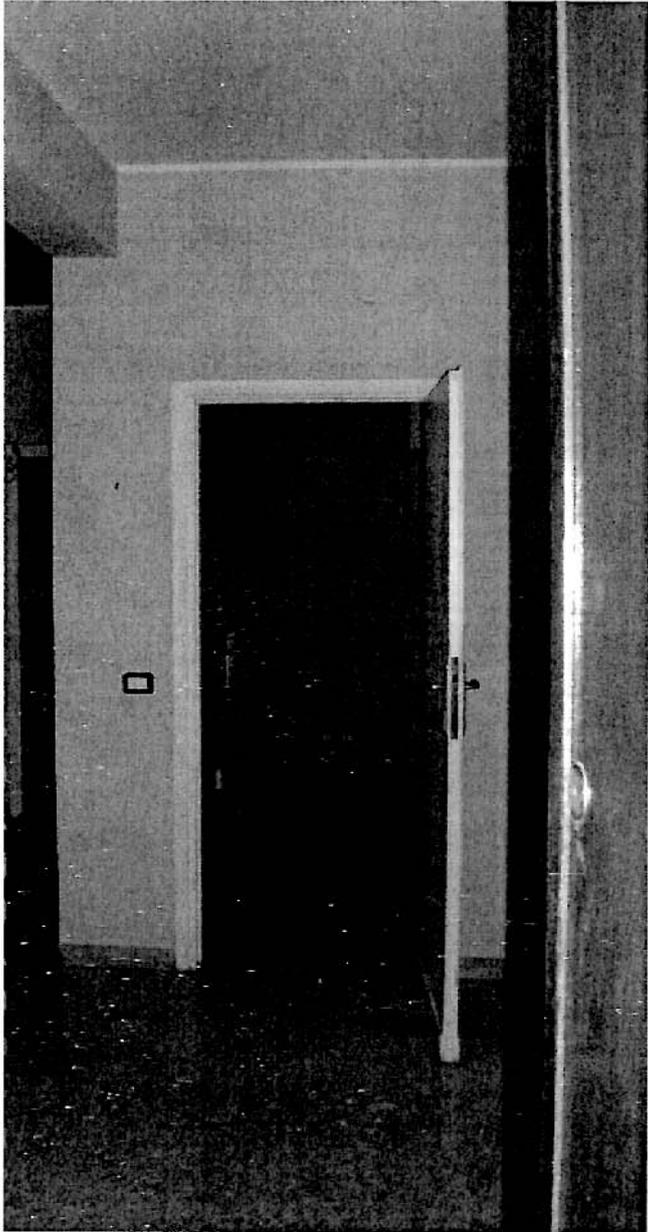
Particolari della pavimentazione corridoio dell'alloggio
